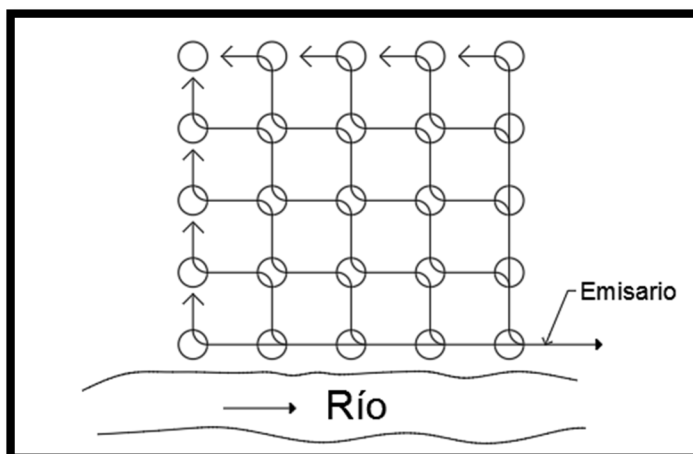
Esquema de un sistema de alcantarillado en bayoneta
